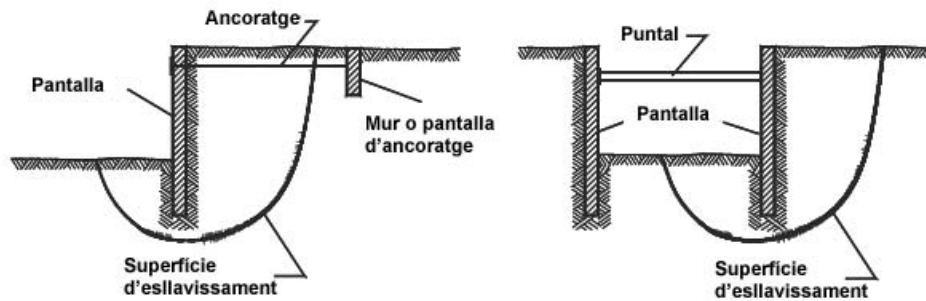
Exemples d'esllavissades profundes que intercepten elements de subjecció
